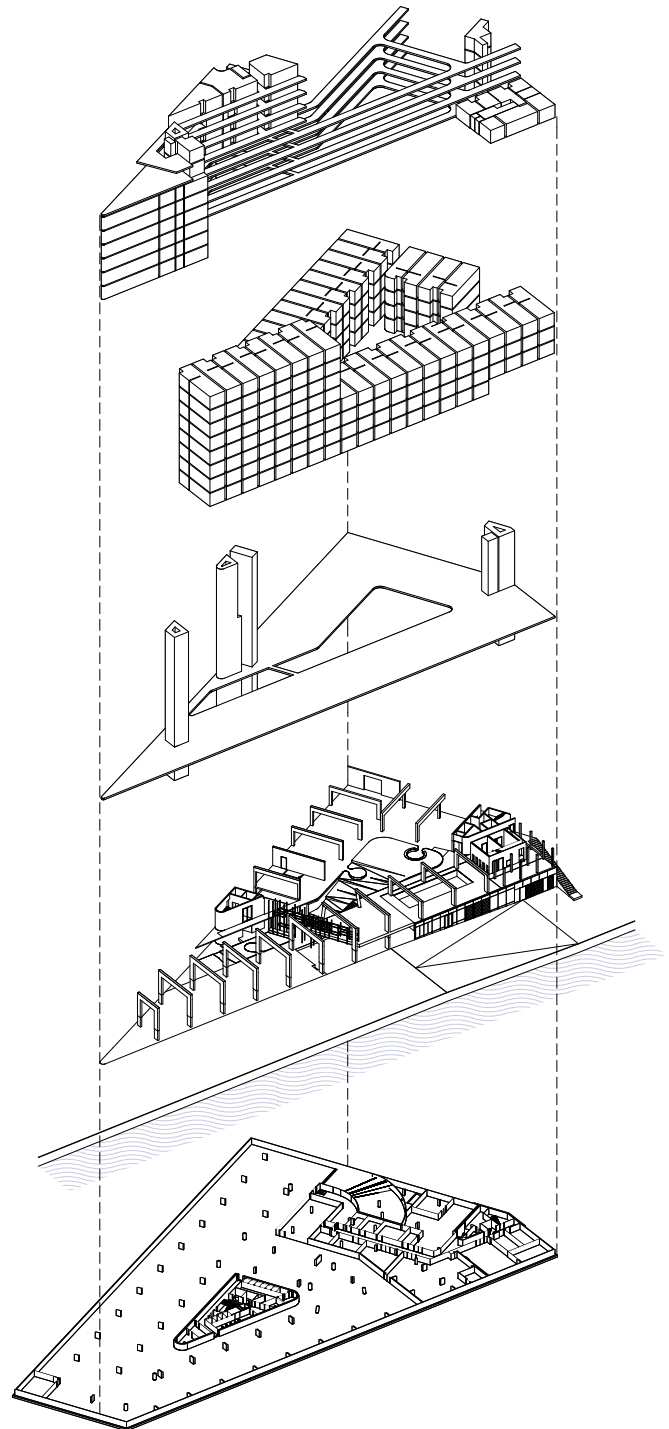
Explosionszeichnung der verschiedenen Tragstrukturen. Dabei stapeln sich die Raummodule aus Holz auf dem Stahlbeton-Sockelgeschoss acht bzw. vier Geschosse hoch. (Bildquelle: SeARCH Architects)
